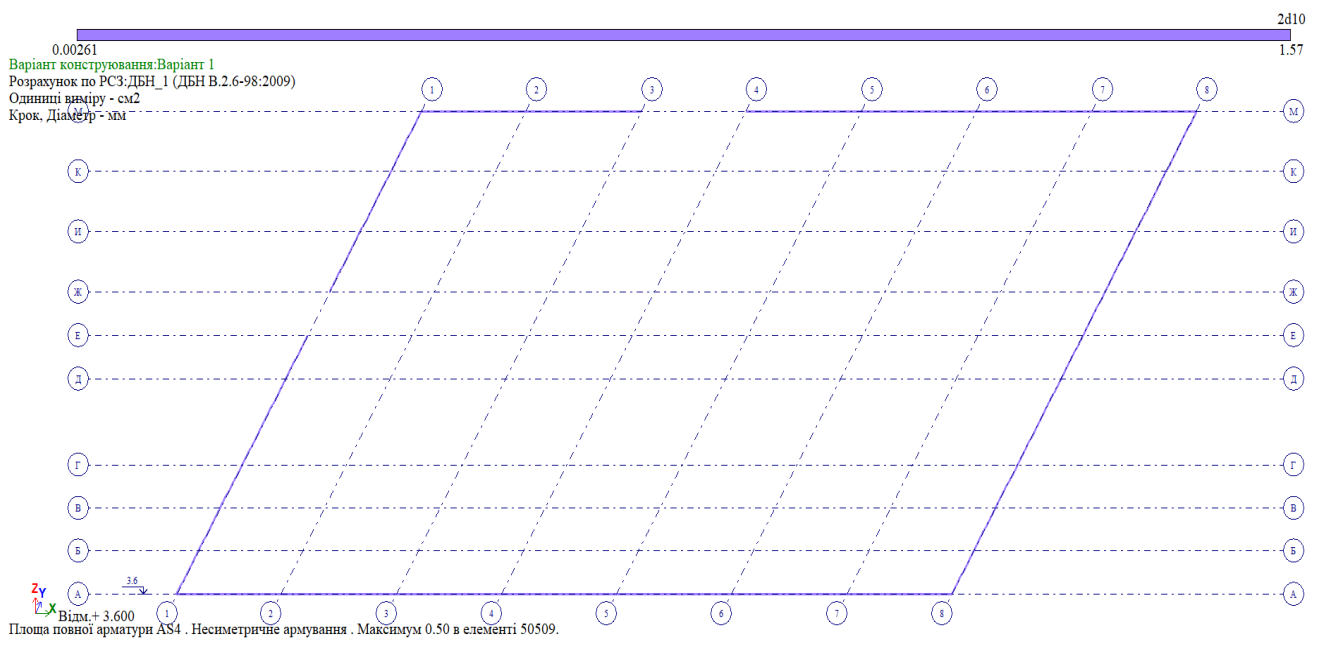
Площа робочої арматури у боковій грані балки Б-1
